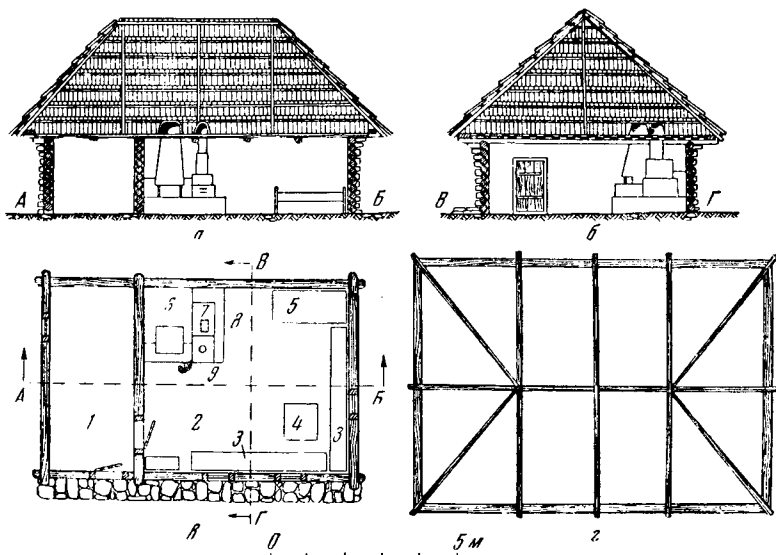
План и разрез дома с холодными сенями в Лунгенах, обл. Броштьень. а — разрез по А—Б; б — разрез по В—Г; в — план; г — конструкция крыши; 1 — сени; 2 — жилое помещение; 3 — лавки; 4 — стол; 5 — кровать; 6 — хлебная печь; 7 — печь-голландка; 8 — дымоход; 9 — плита
